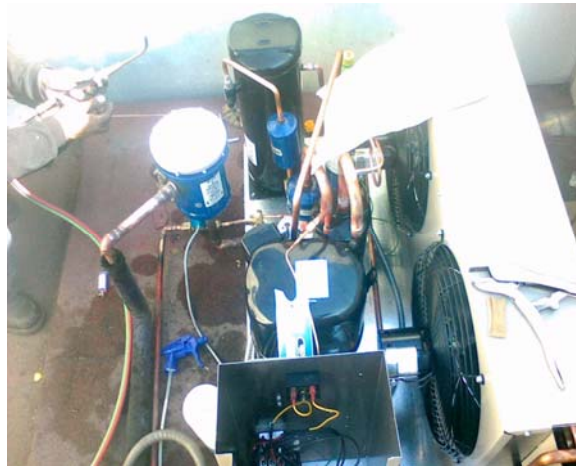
sellado de tubería para evitar la fuga de refrigerante para lo cual se usa soplete y soldadura de tungsteno.
